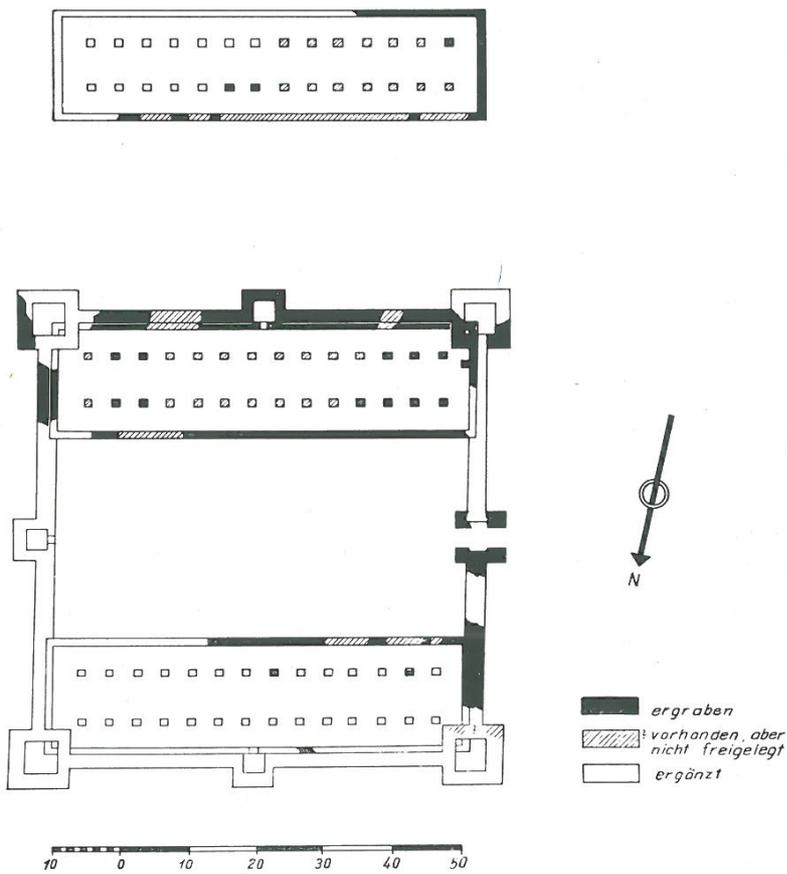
Veldidena: Rekonstruktion des Grundrisses
